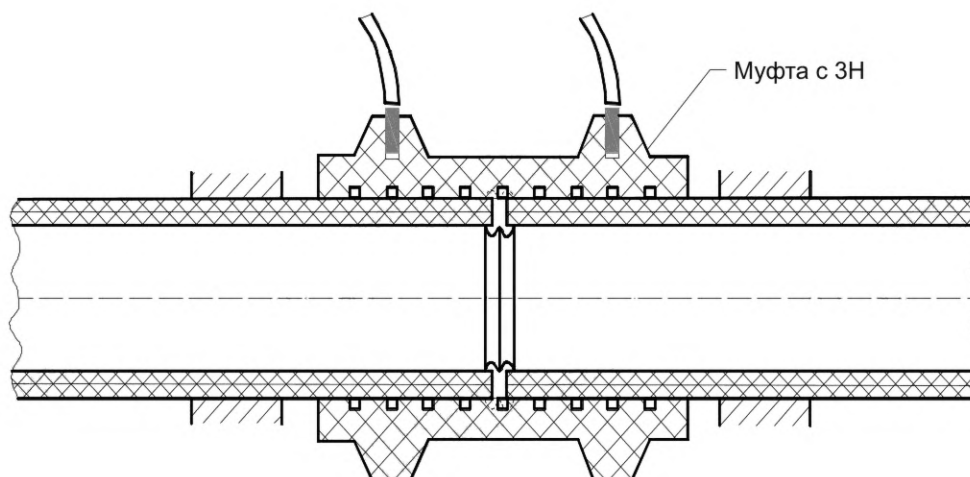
Удаление грата и усиление сварного шва СД ПАТ (муфтой) с ЗН
